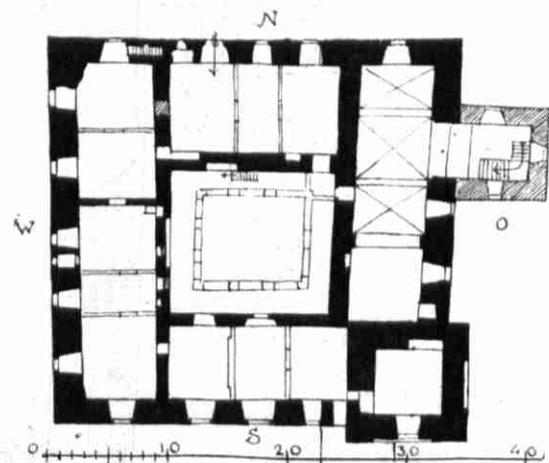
Komturei Windau. Grundriß des Hauptgeschosses. (M. 1:600.)
